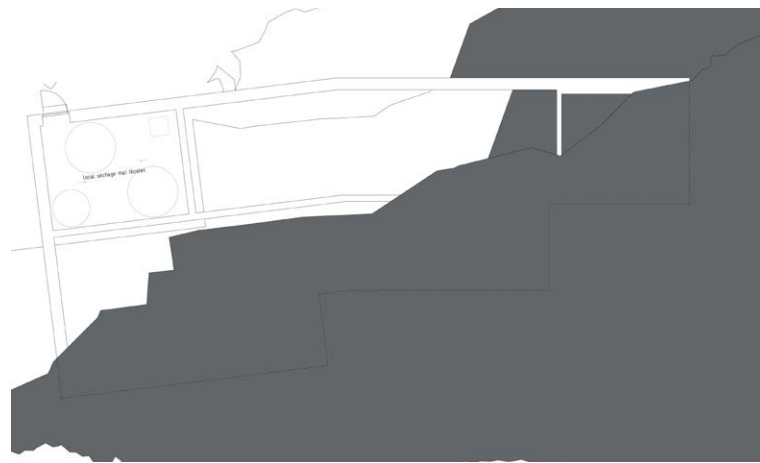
Pianta piano secondo seminterrato del Tracuit Hütte
